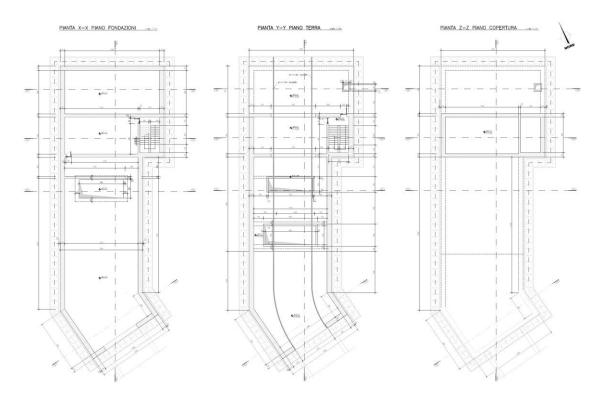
Rampa di accesso alla galleria di sfollamento, piante
